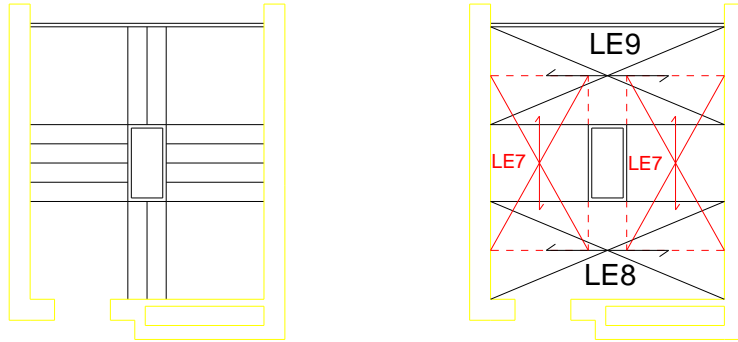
Planta arquitetônica e estrutural LE7, LE8/LE12 e LE9
